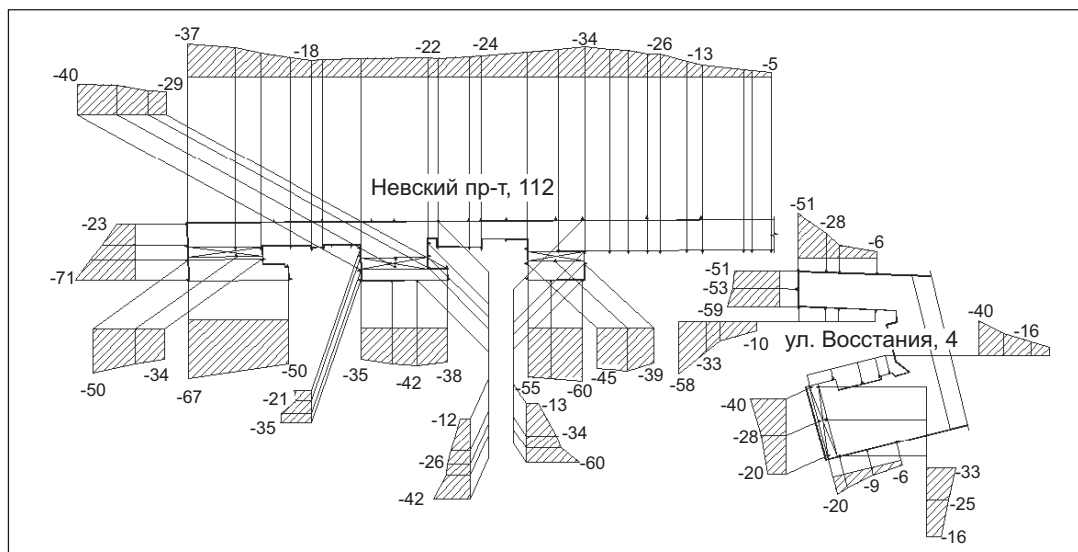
Эпюры развития осадок соседних зданий на момент, предшествующий откопке котлована
